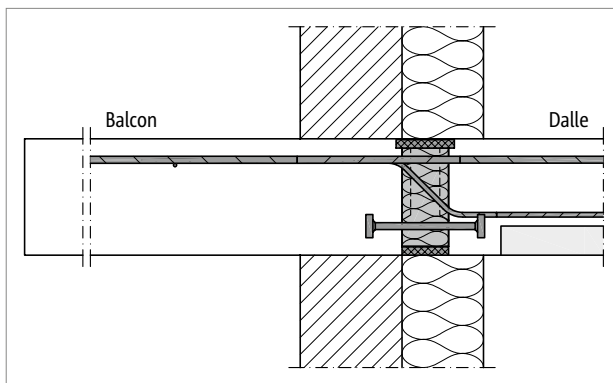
Schöck Rutherma® T type DB : liaison pour balcon en béton dans le cas d'une façade en maçonnerie et plancher constitué de prédalles
